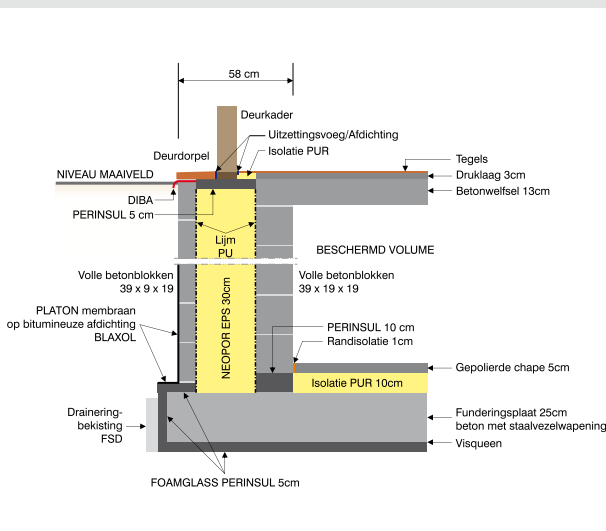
Constructiedetails van keermuren en funderingsplaat
